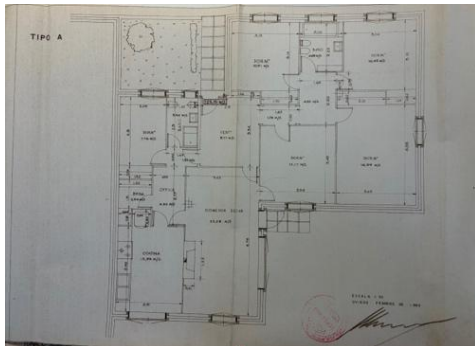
Plano de la vivienda de la I Fase, correspondiente con la tipología A, proyectada por Igancio Álvarez Castela para los empleados de la central de Arbón (Archivo Histórico de Asturias: Fondo Colegio Oficial de Arquitectos de Asturias, Caja 175607/16).
